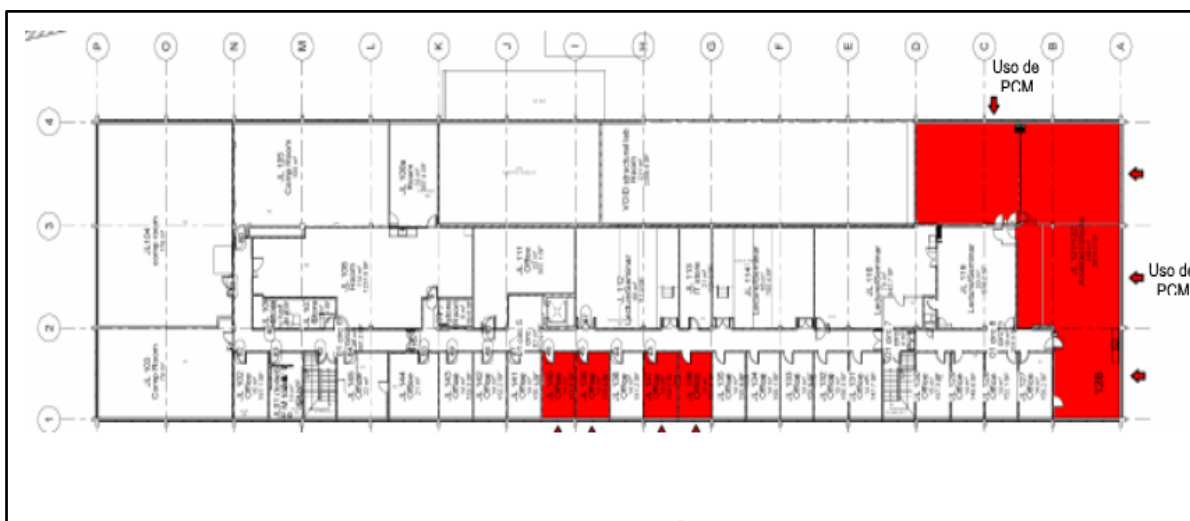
Planta do 2º piso onde foi instalado o PCM no teto [84]
